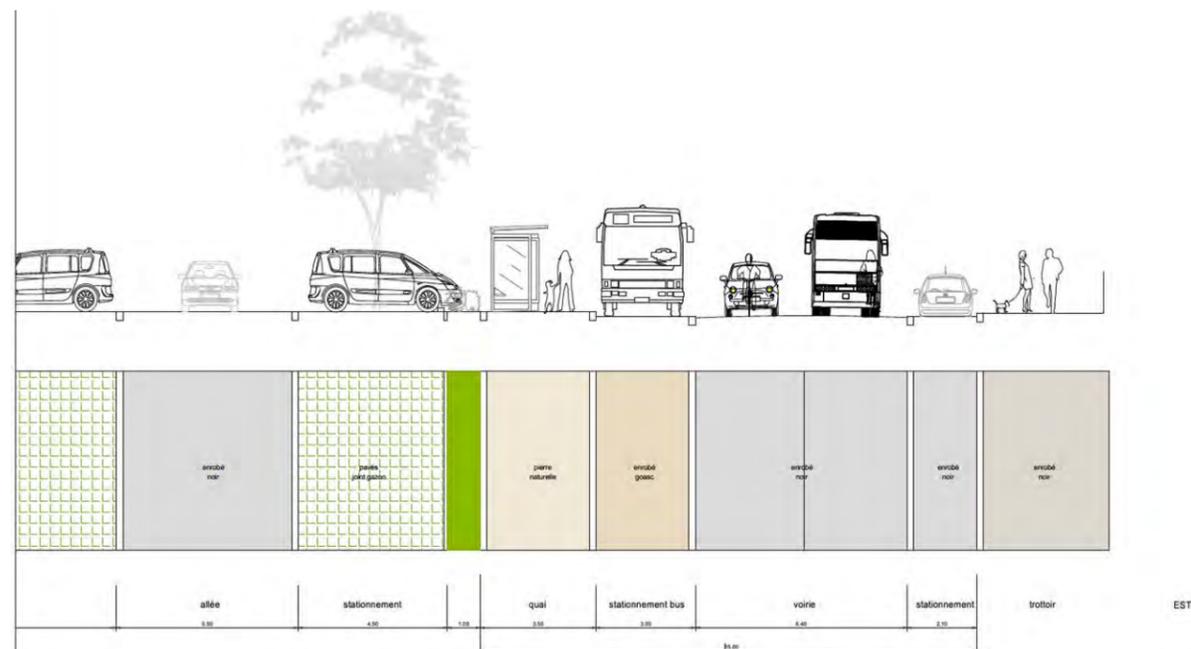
Profil-type de la rue de l'Avenir (Source : EGIS, mai 2022)
